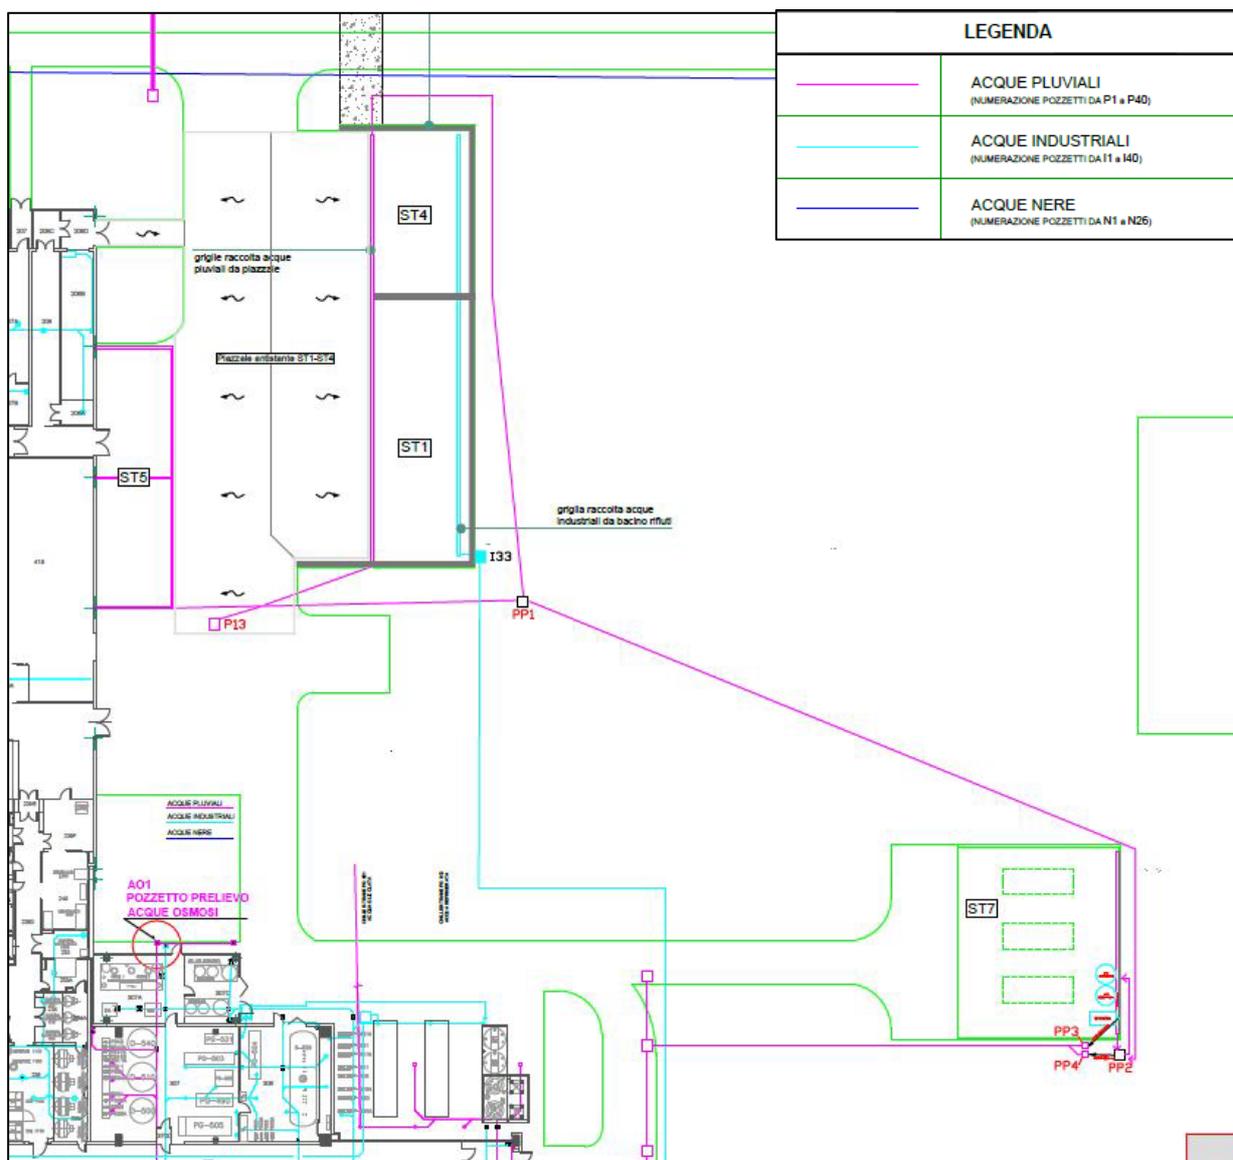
Layout della rete di drenaggio acque meteoriche e dell'impianto di depurazione
